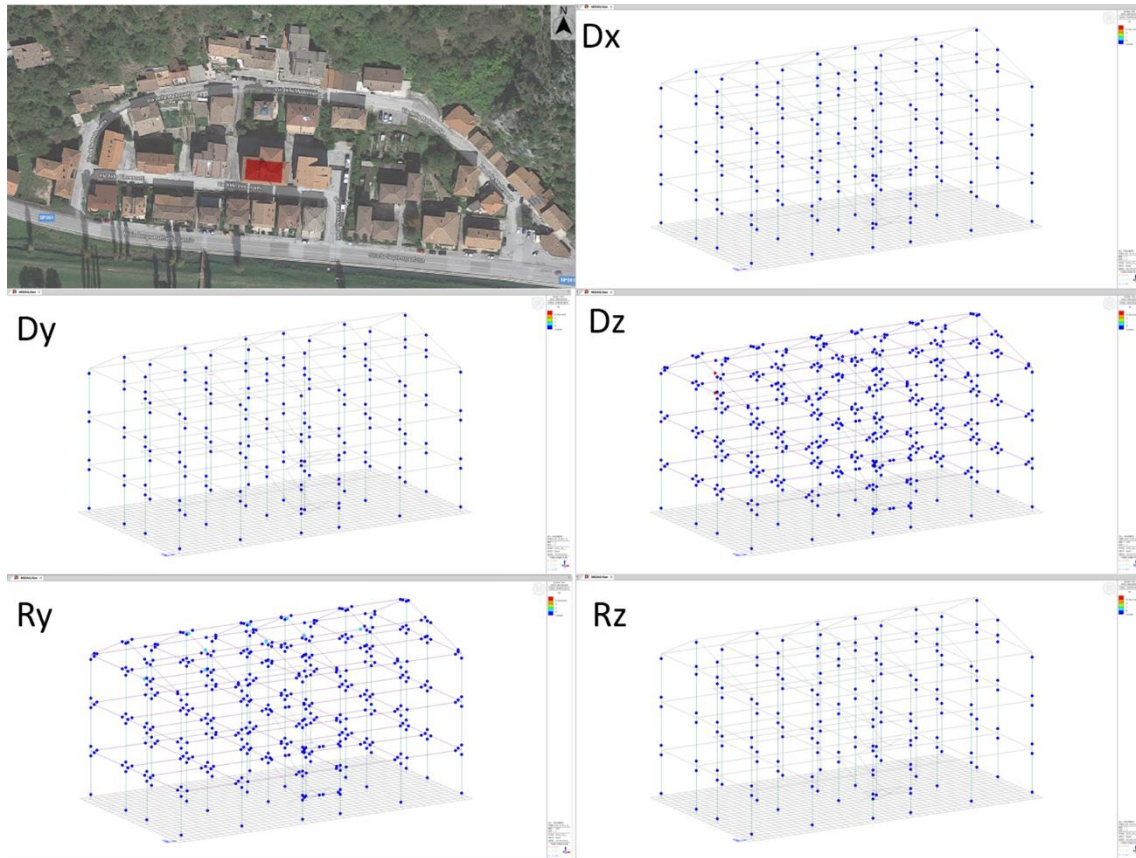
Cedimento fondale applicato ad un edificio in c.a. a tre piani con platea di fondazione nella POSIZIONE 2 all'interno del quartiere "Madonnetta" del comune di Pioraco.
